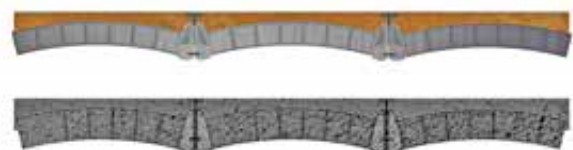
Viguetas metálicas y entrevigado sobre rasilla
